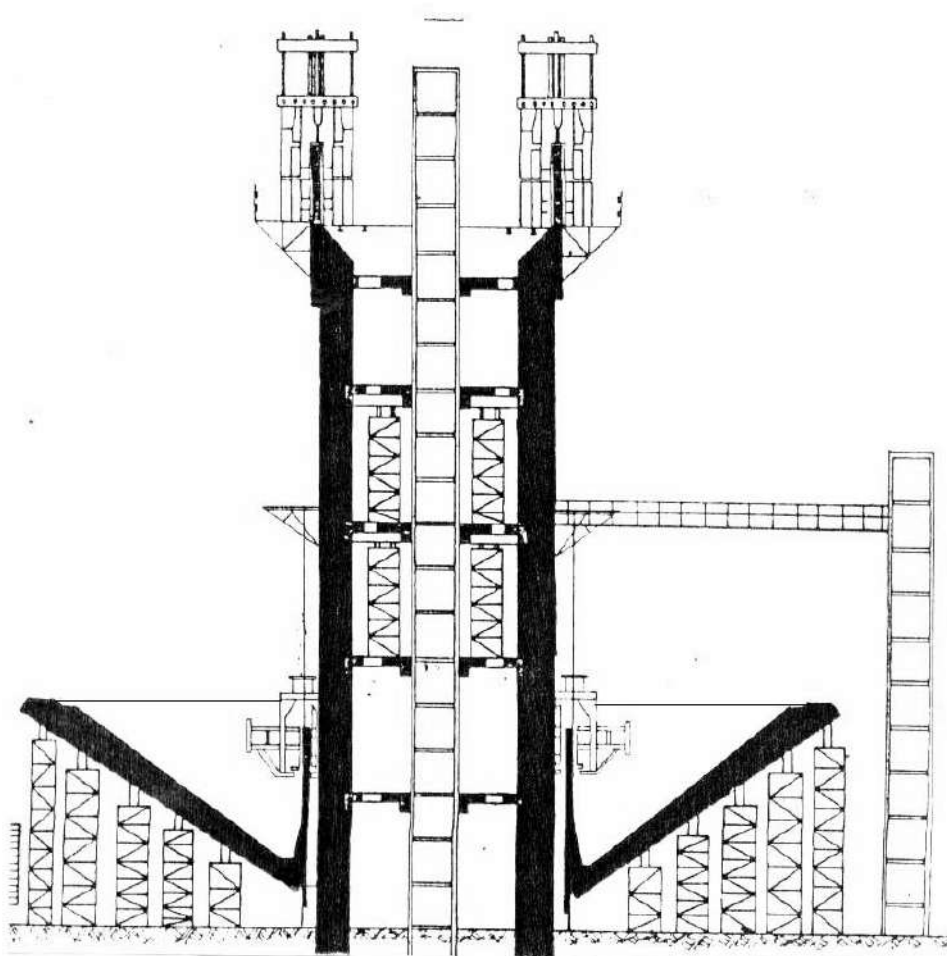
Seção transversal da caixa d'água em construção por ocasião da inspeção
